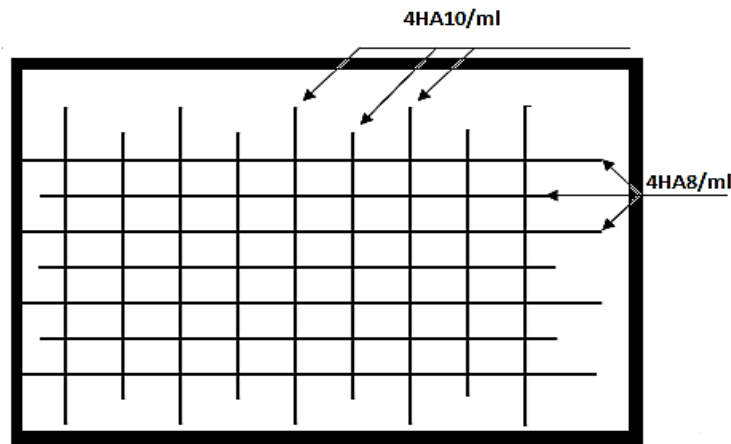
Schéma de ferrailage de la dalle pleine sur 4 appuis
